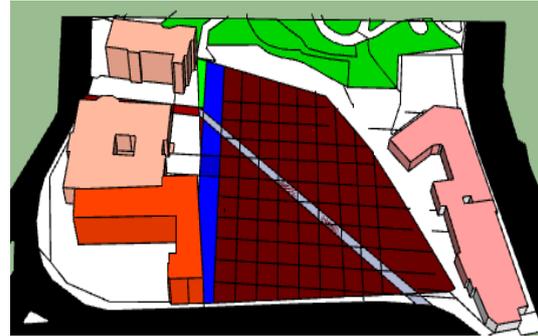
plans de situation de la parcelle avec la rampe urbaine et de la trame
